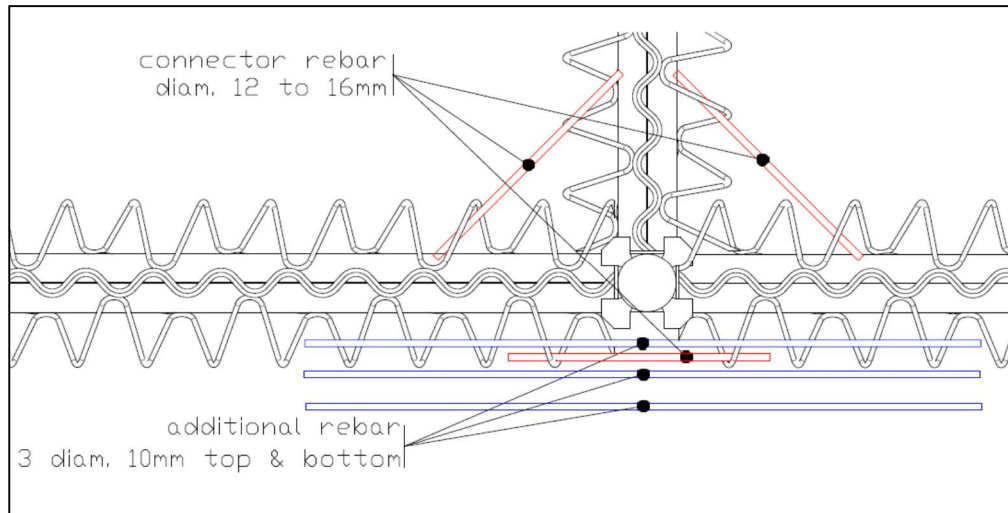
Bewehrung an Kreuzungselementen und zusätzliche Bewehrung für T-Kreuzungen.
